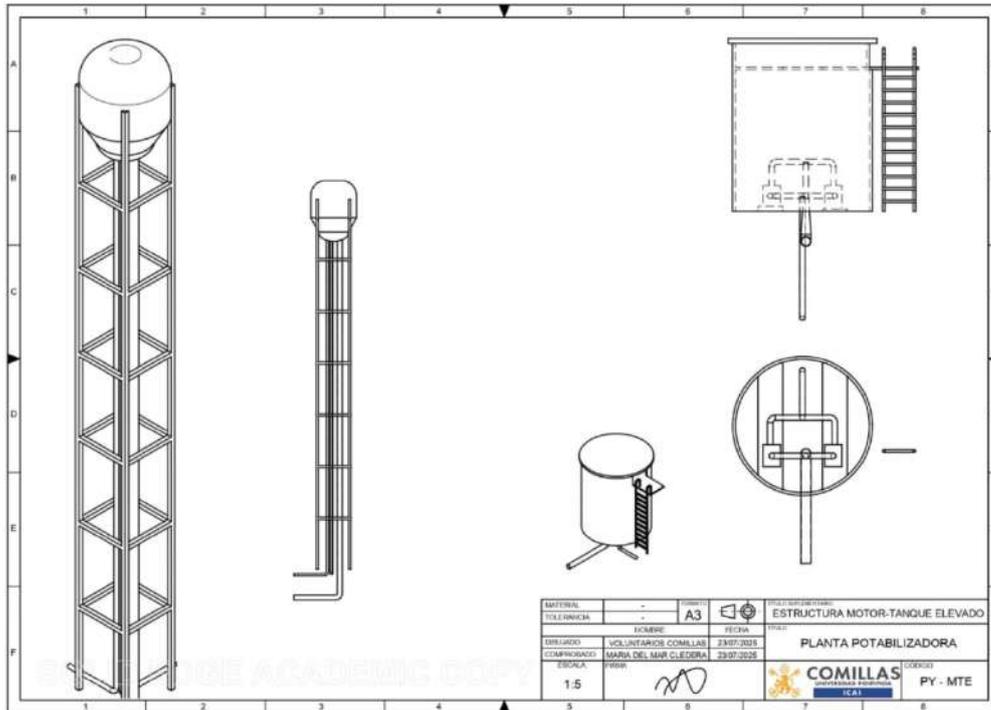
Plano del tanque elevado a 23 metros y la estructura que aloja los motores de succión
